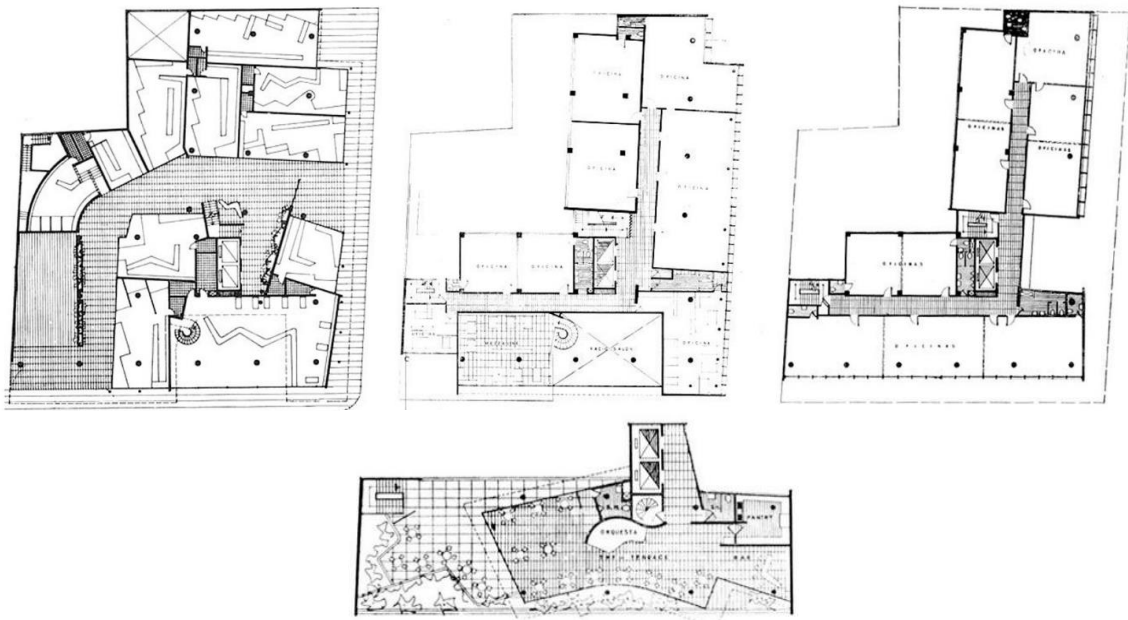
Vista planta del primer (izq. superior), segundo nivel (centro superior), planta típica (der. superior) y del último piso (centro inferior) del edificio Seguros Atlas
